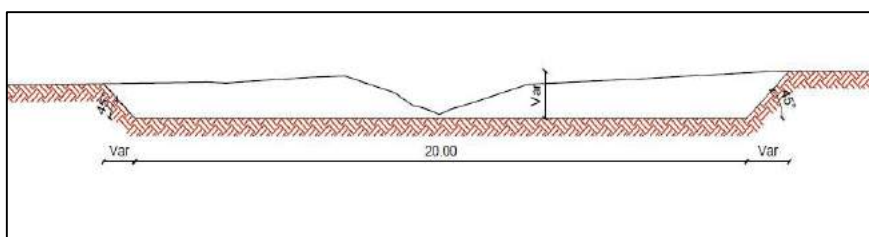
Sezione tipologica sistemazione alveo in progetto
